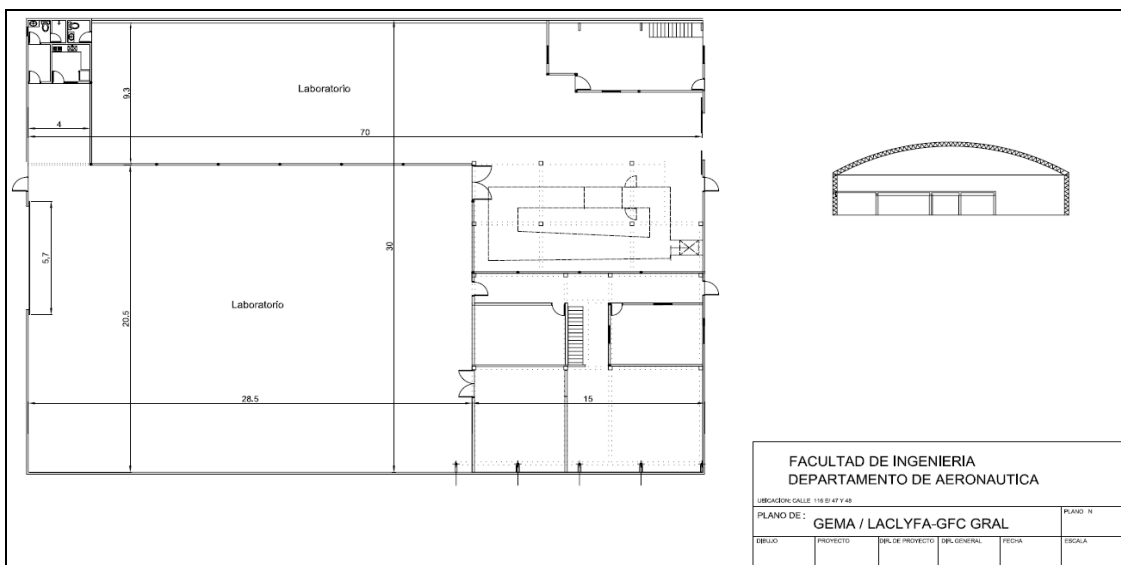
Plano general del Edificio (LACLYFA- GFC – GEMA) en obra
